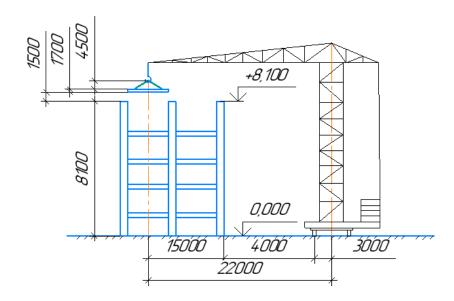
Схема определения монтажных характеристик башенного крана на самый удаленный элемент
